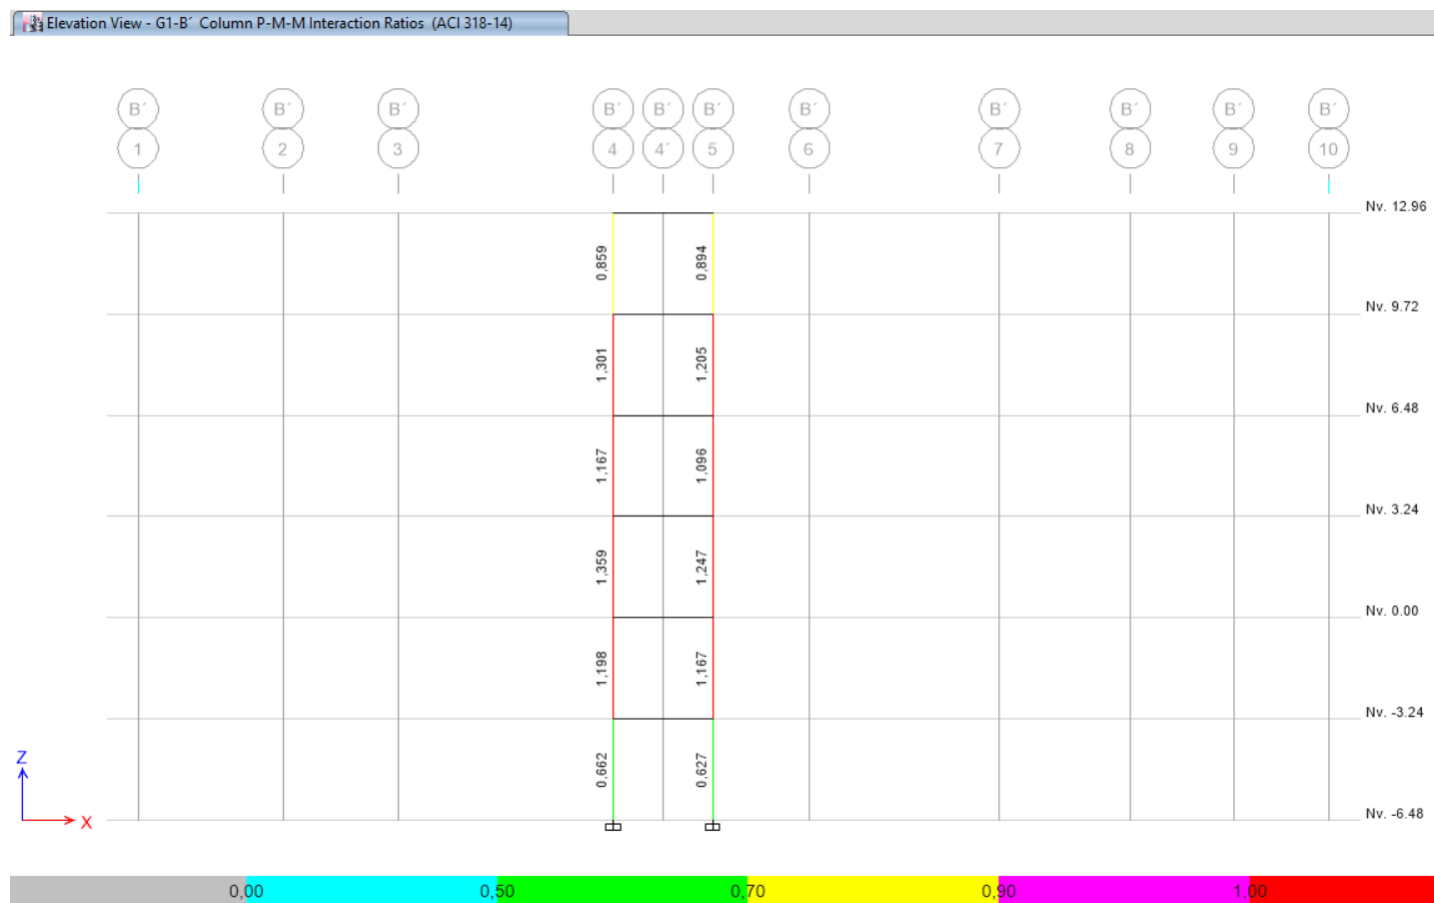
Vista en elevación de la demanda/capacidad en columnas, pórtico eje B.
